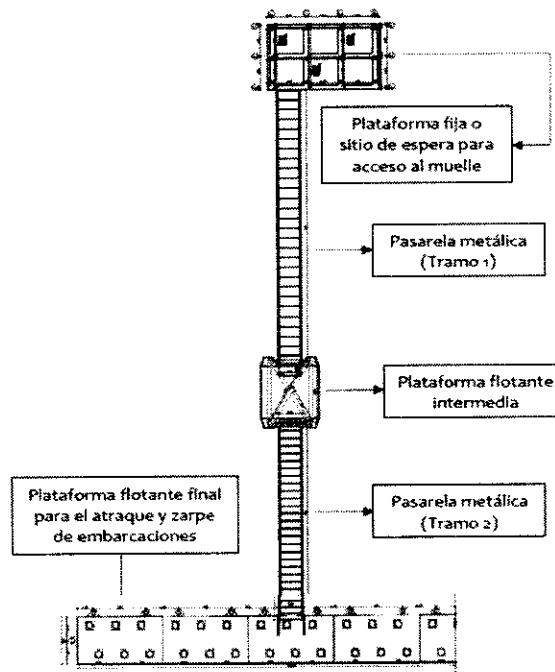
Planta estructural del muelle fluvial proyectado de Noanamá, Chocó
